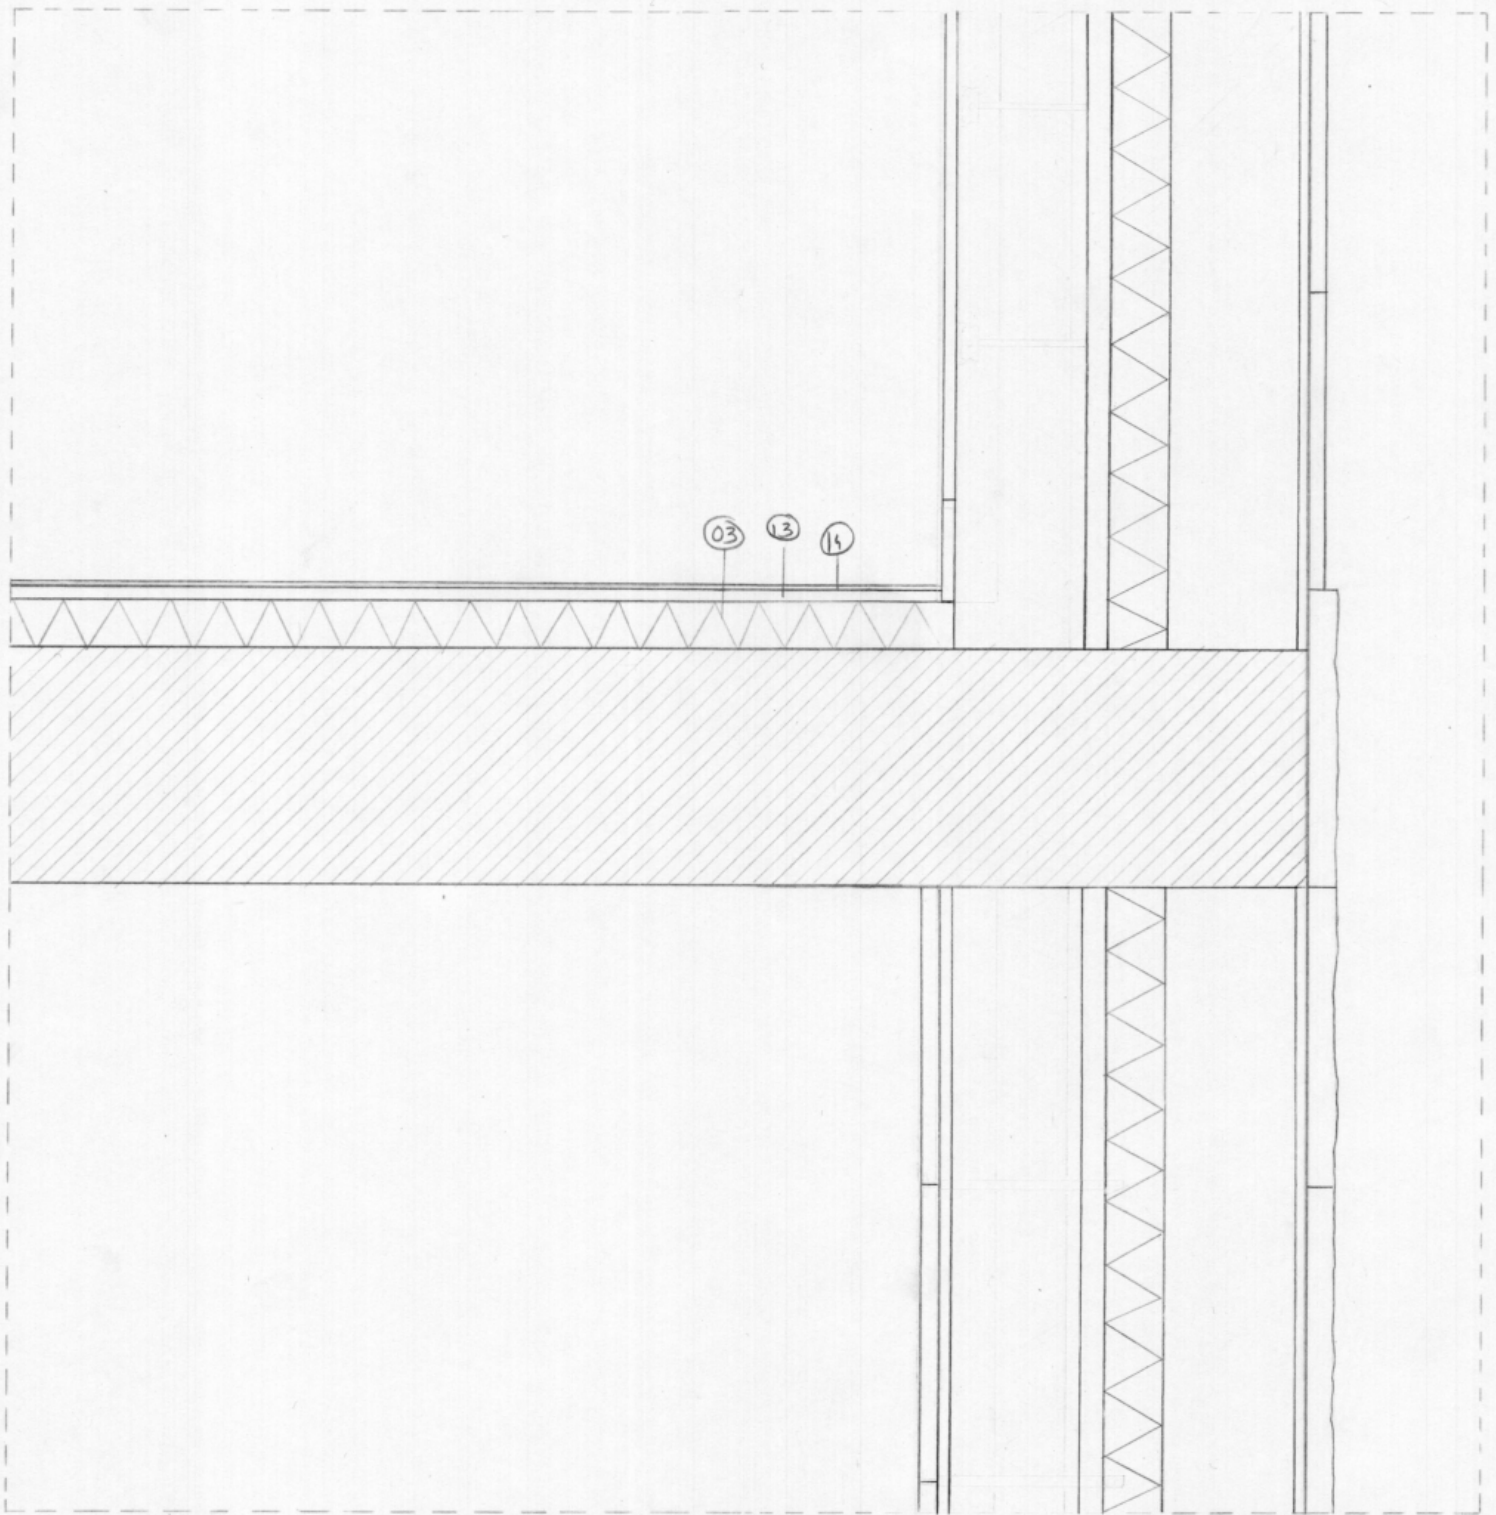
D2 - Detalhe do encontro da laje com a parede, escala 1:10.
